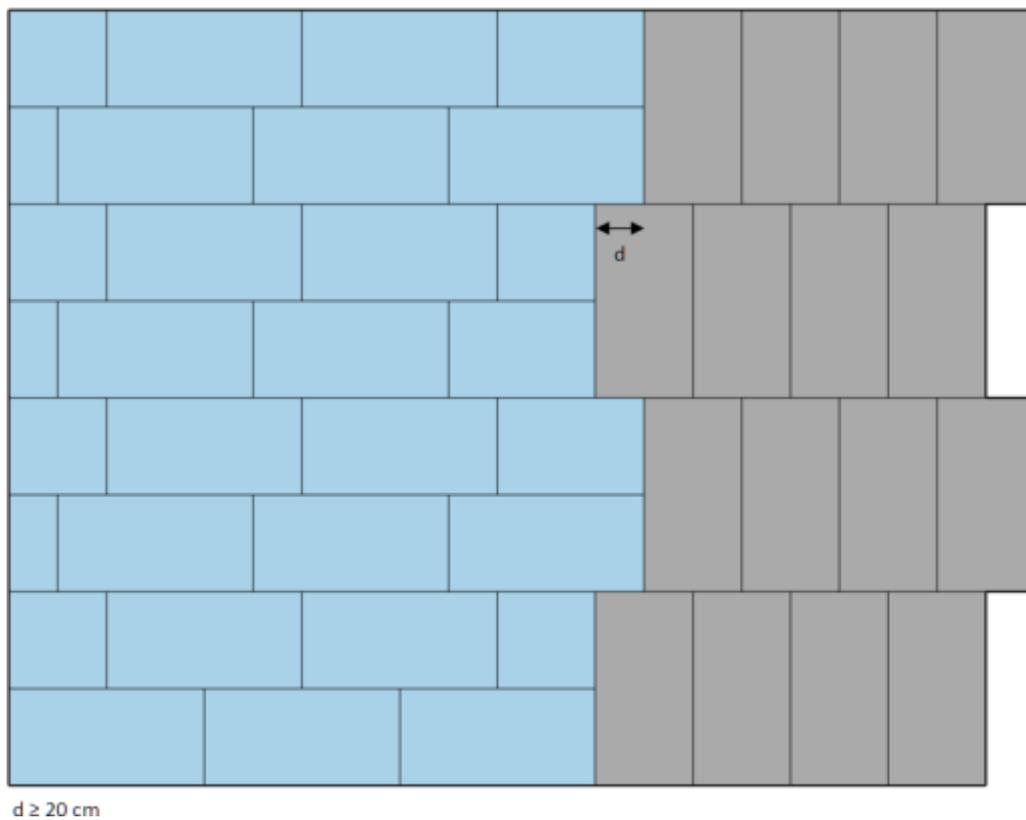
Juxtaposition des poses horizontales et verticales des panneaux isolants sur une même façade
